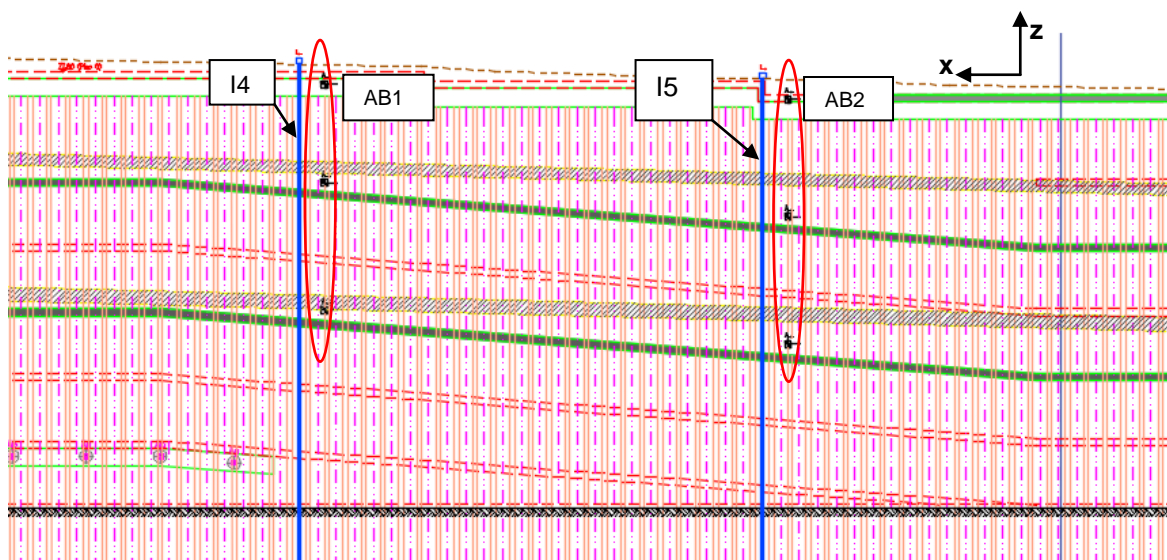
Nova disposição do conjunto estaca + inclinómetro, planta e aplicação prática.
